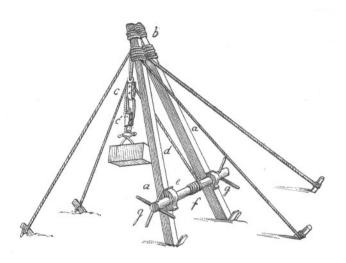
Máquina de elevação. (publicada por Navarre, 1904: 1463)
